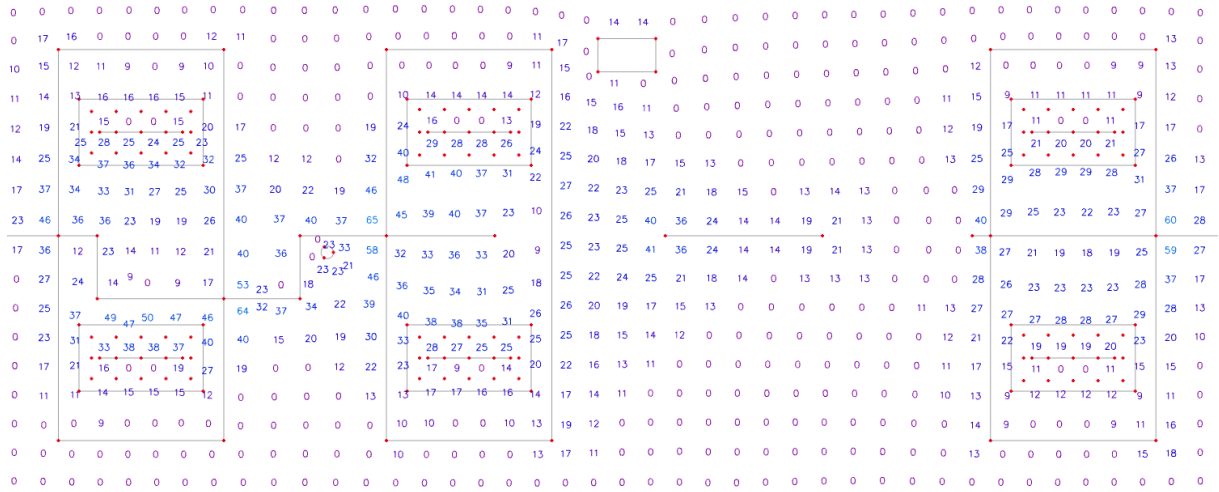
Nutná horní výztuž ve směru Y rovnoběžném s osou trámu [cm²/m]
